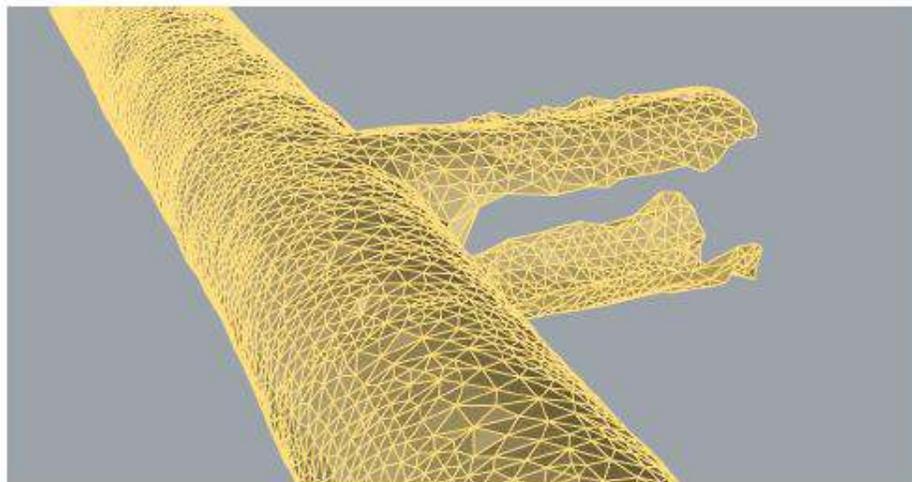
Vista 3D de la conexión a chimenea de equilibrio. Elaborada a partir de levantamiento sonar realizado durante la inspección.
